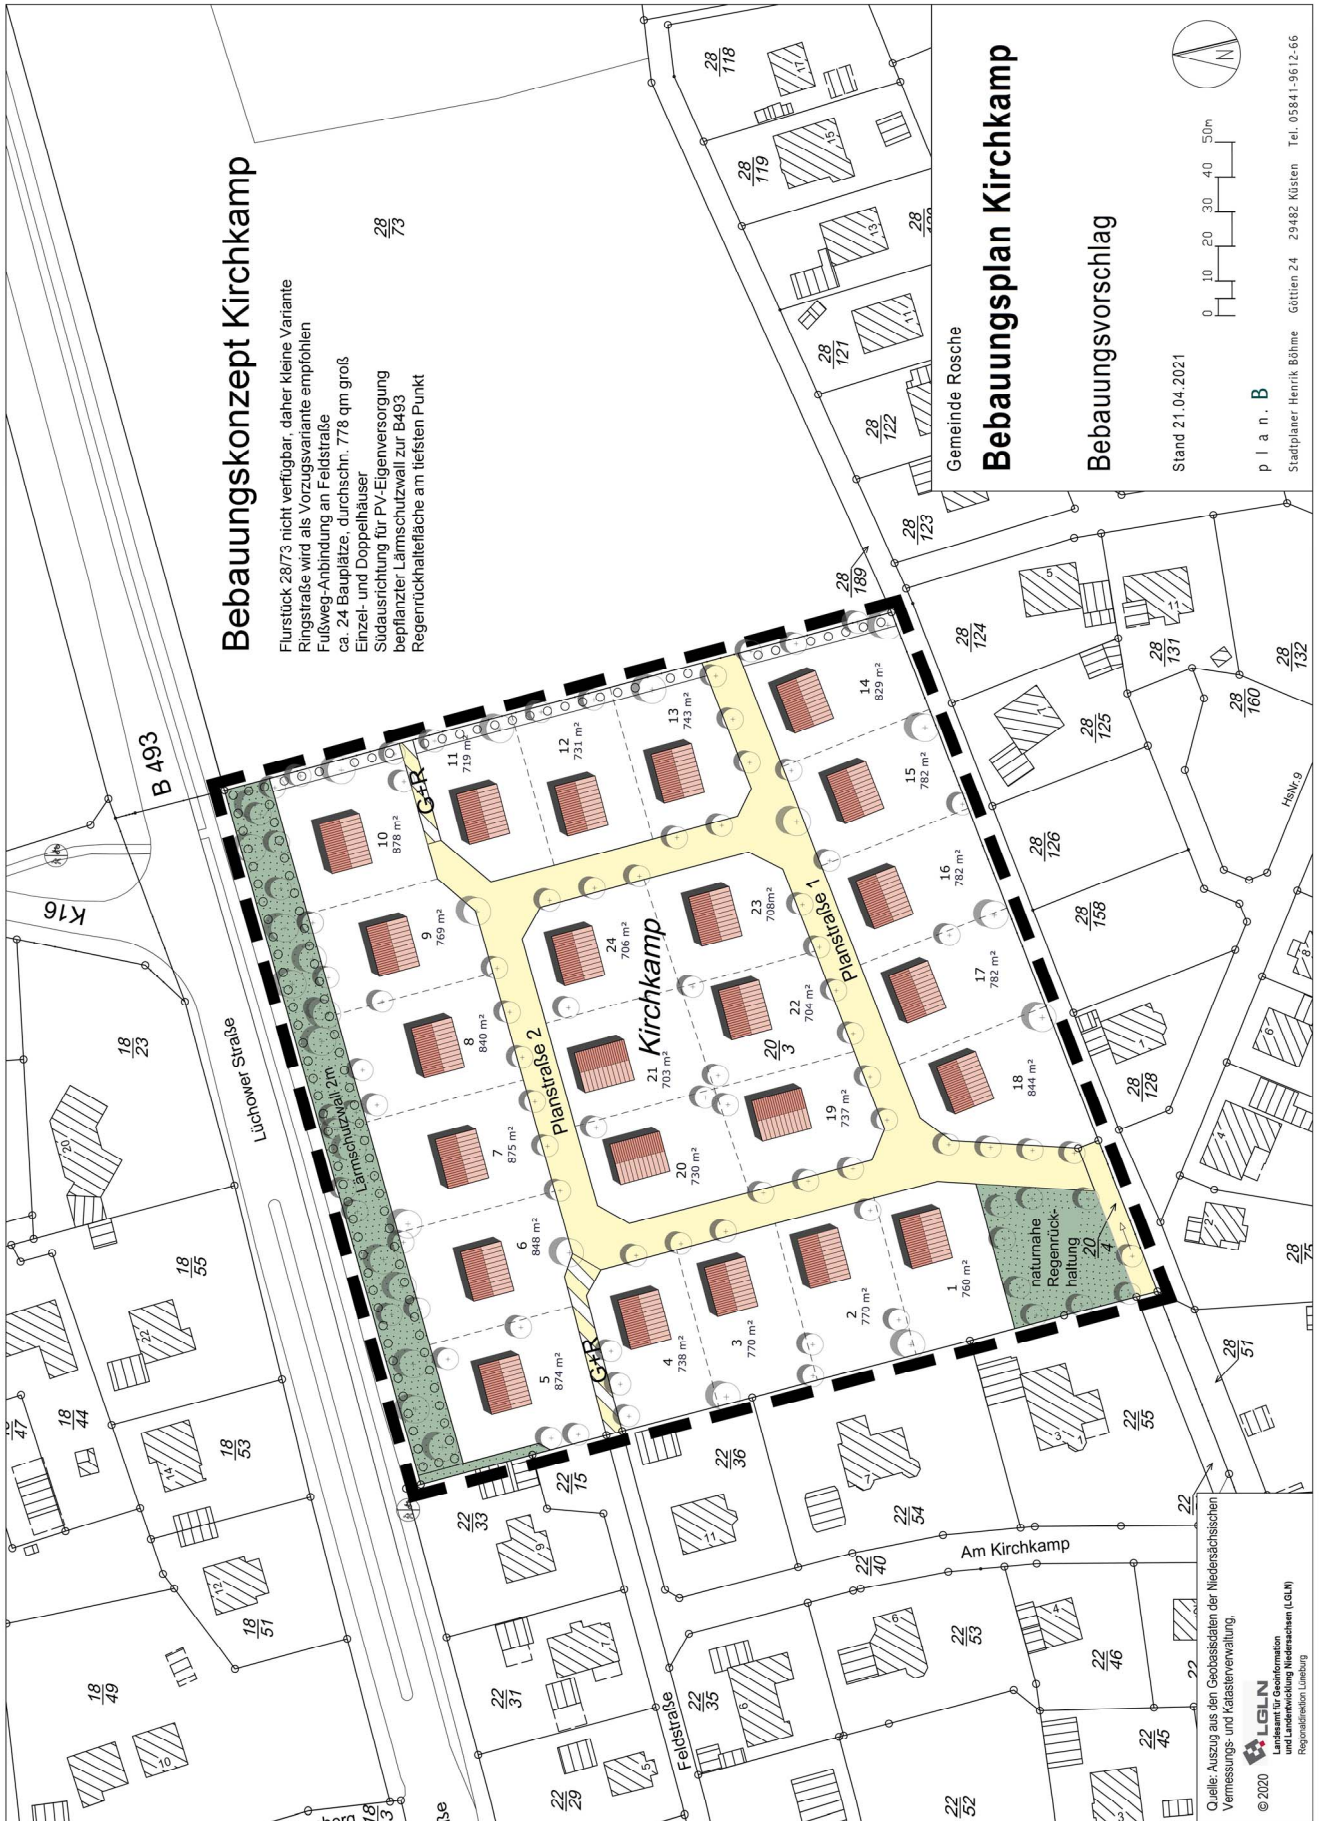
Bebauungsvorschlag der Gemeinde Rosche, plan.B, April 2021
